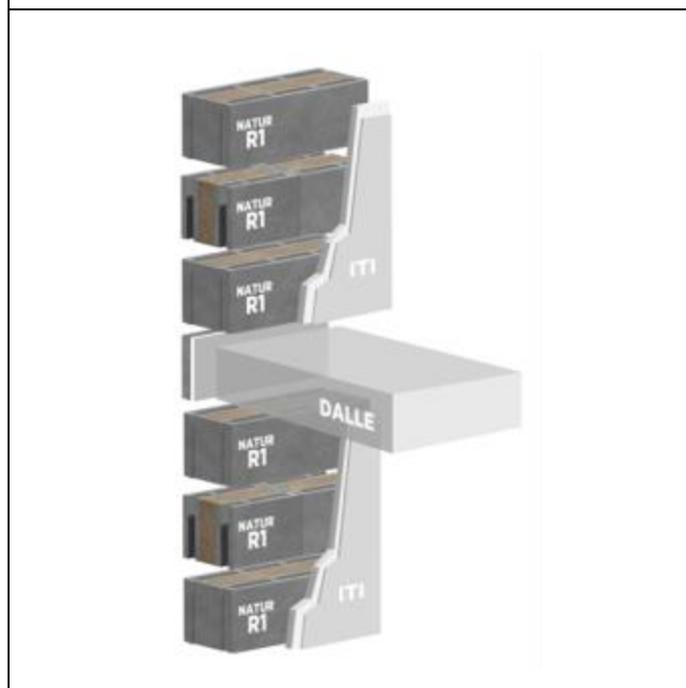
Chaînage horizontal (appui de plancher) – Mur « R+Mur N »
